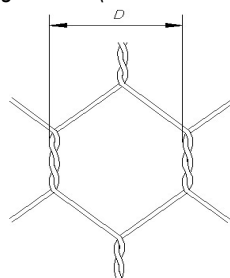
Abertura hexagonal de la malla gavión. (Cortesía de Gaviones Bekaert).
